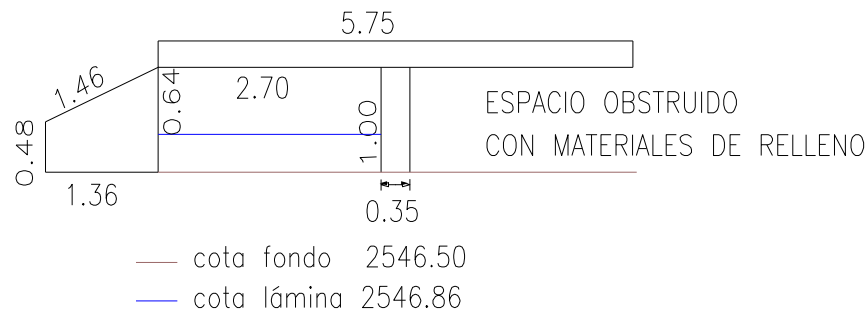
Dimensiones del Box Culvert de la calle 222 (Fuente: EAAB-ESP)
